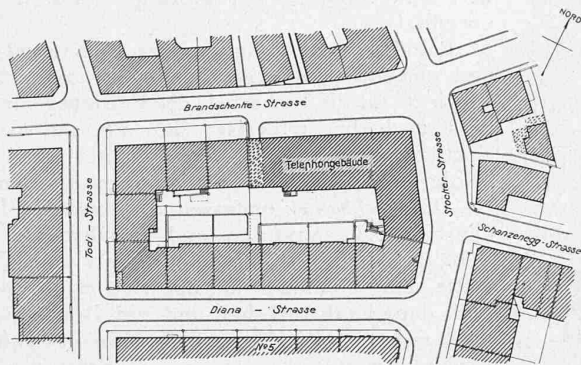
Lageplan der Telefon-Zentrale Selnau. — 1:2000.
